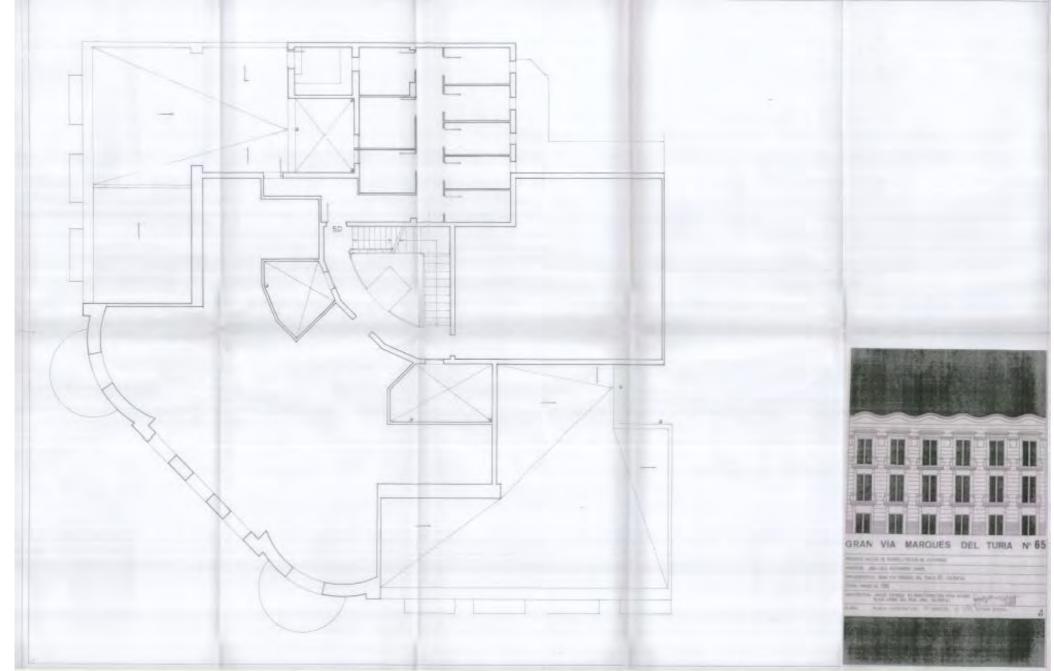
Planta quinta estado actual proyecto de rehabilitación 1985
